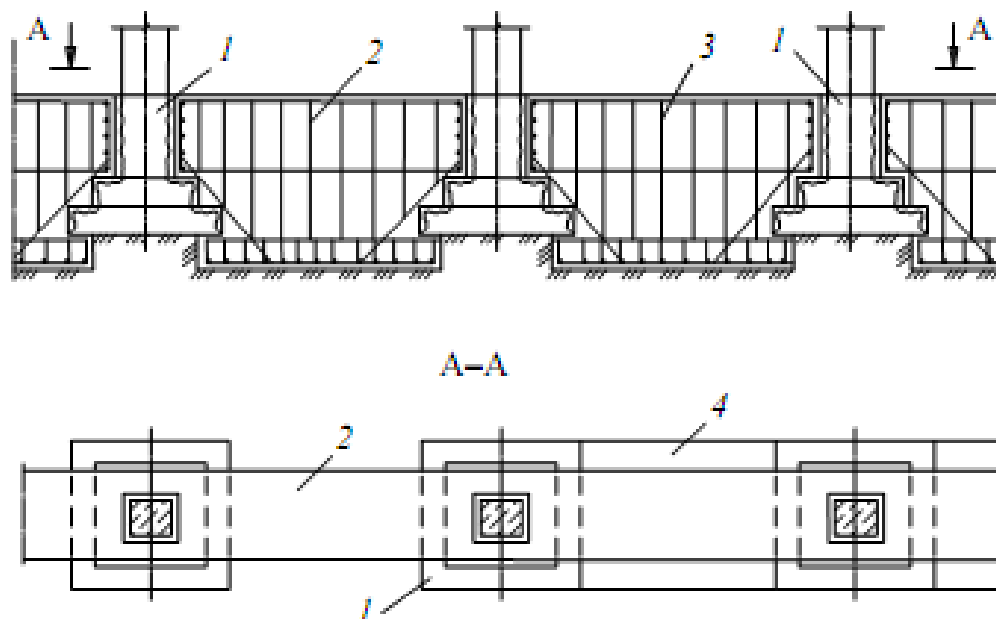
Перебудова стовпчастих фундаментів у стрічкові:
